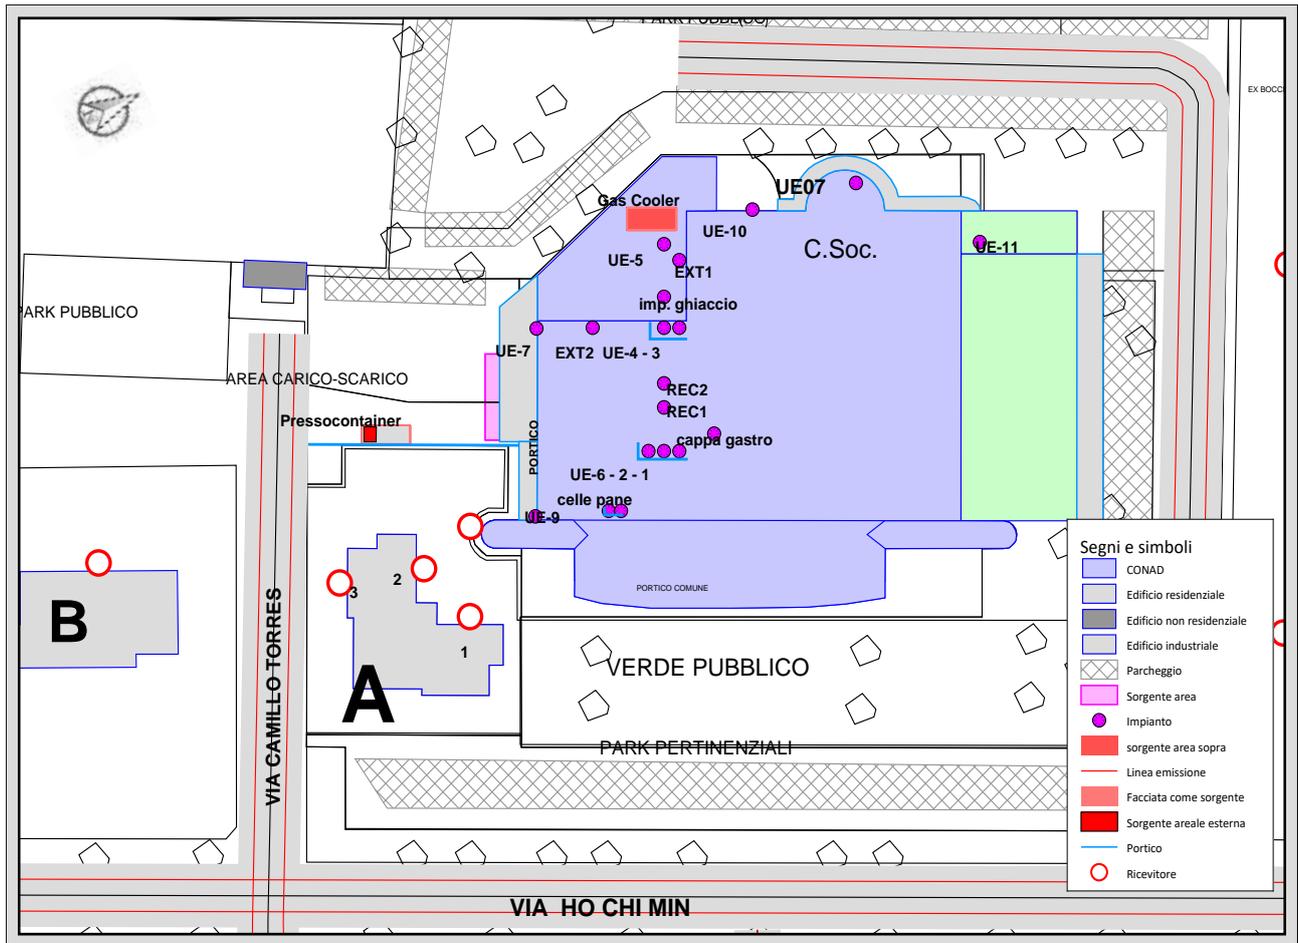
a – planimetria di progetto con indicati gli impianti rispetto ai più vicini ricettori ricettori individuati (A ed B)
